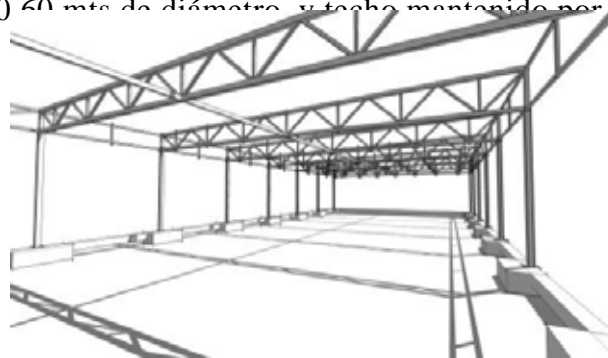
Estructura metálica cancha techada. Fuente: [www.artchist.blogspot.com](http://www.artchist.blogspot.com) (2017)
